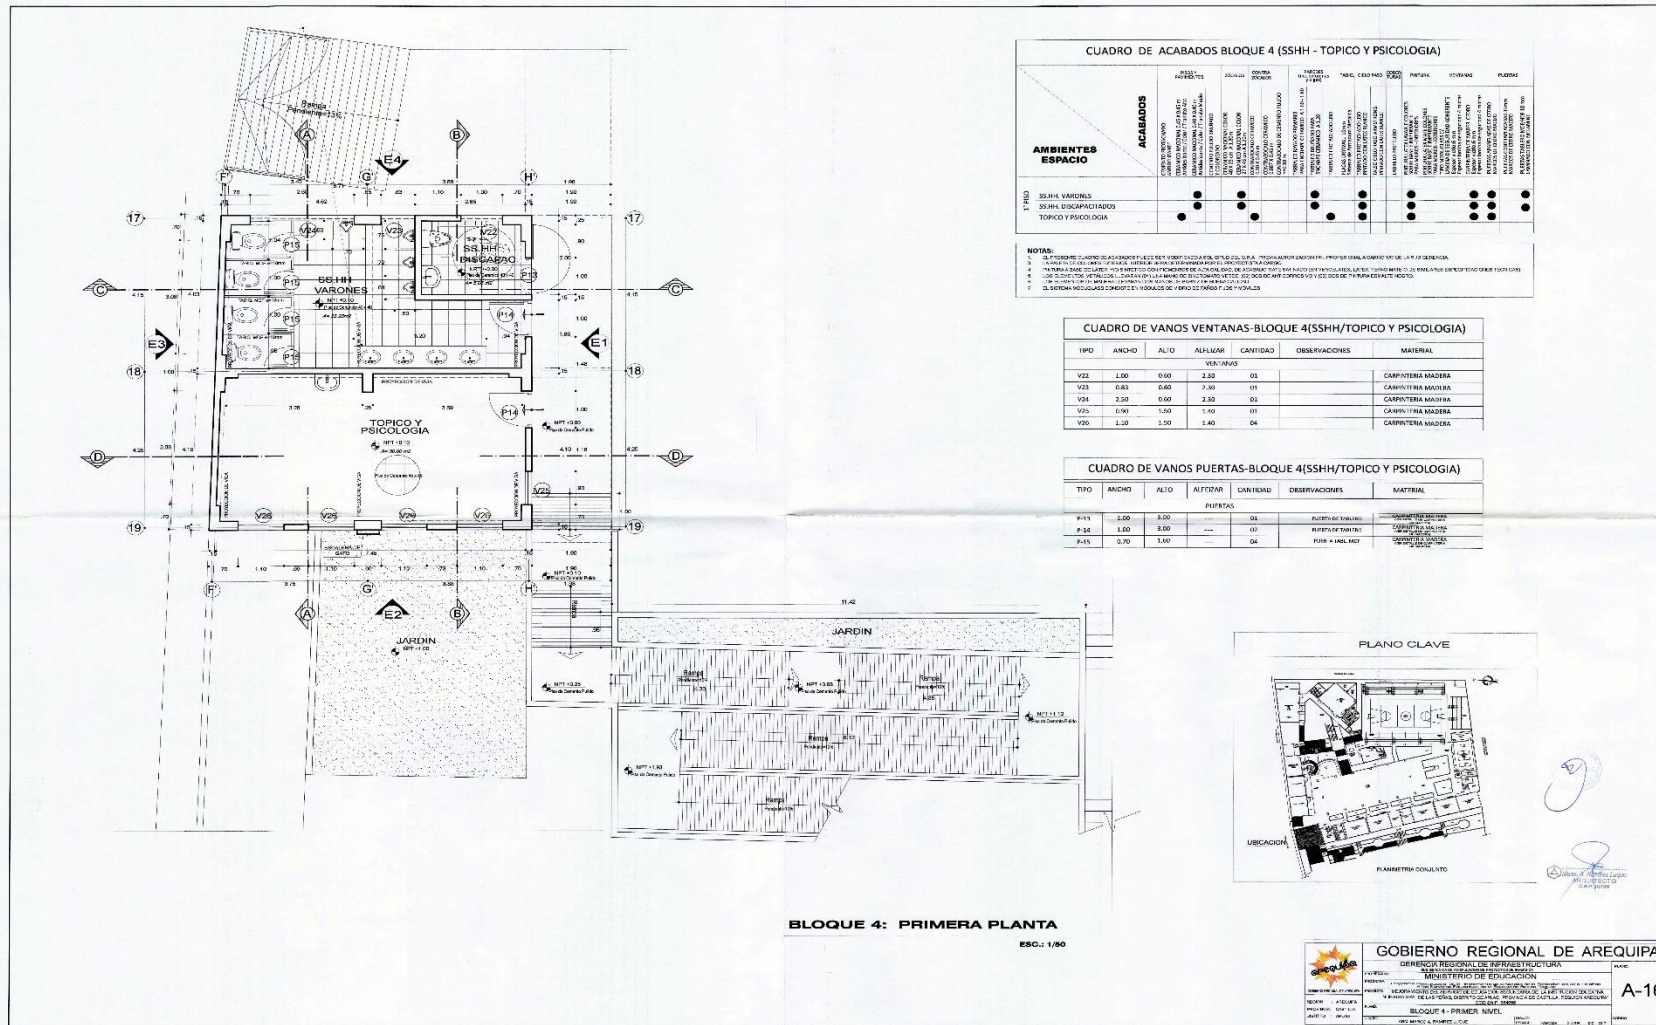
Plano de arquitectura – Planta del bloque 04 tópic y psicología.
